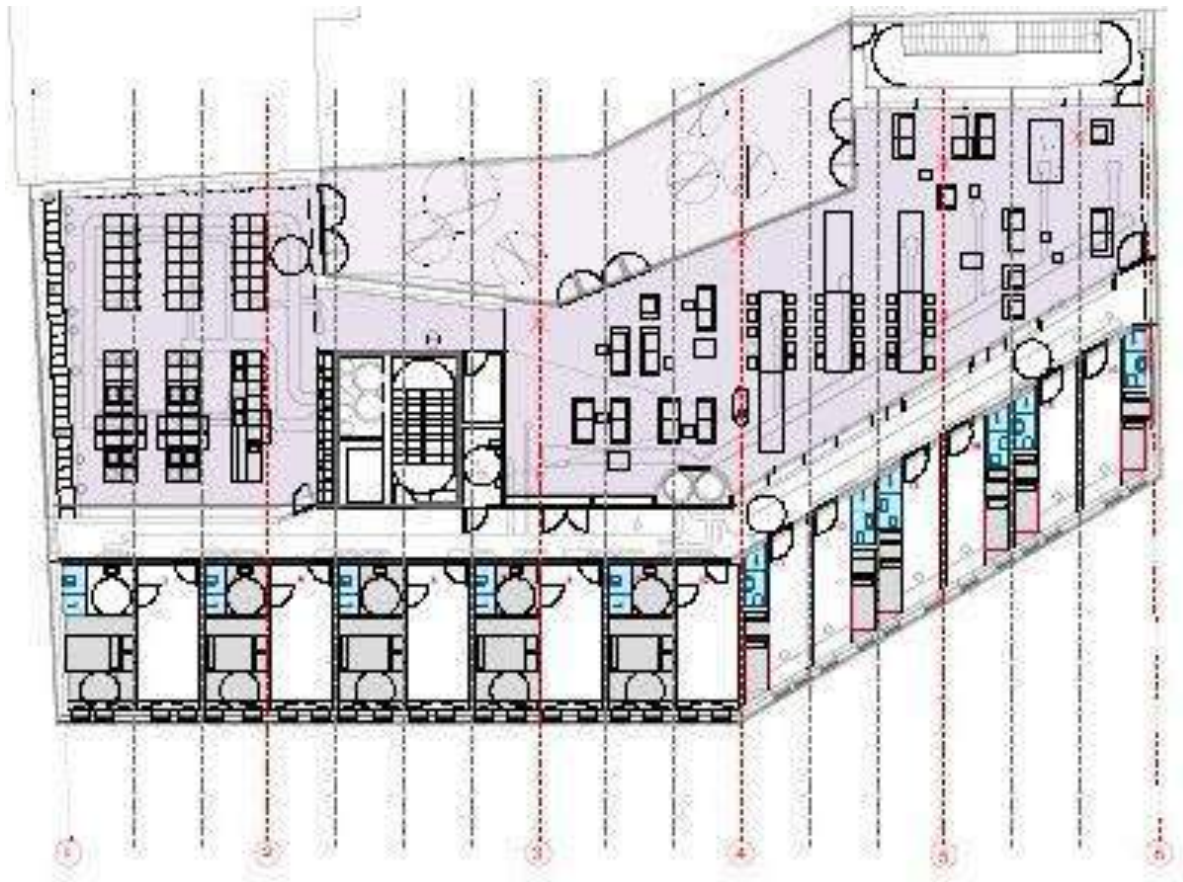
Grundriss 1. Obergeschoß MySpace
